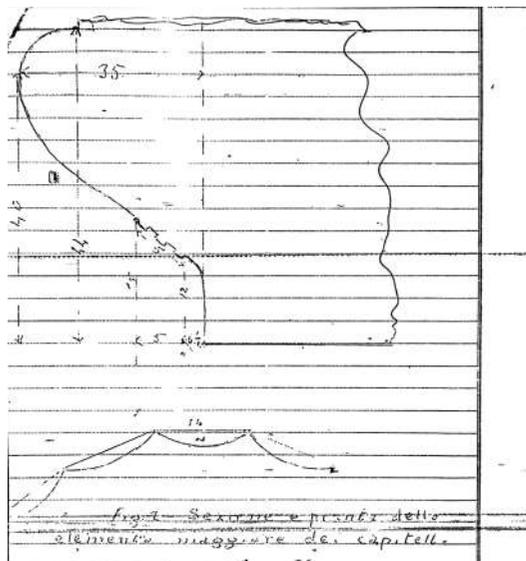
Sezione e pianta dello elemento maggiore dei capitelli
